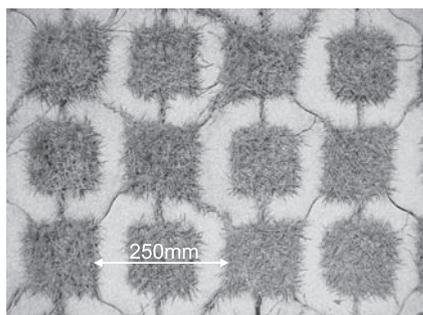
打ち水ガラスパーク表面の様子 (施工約1年後)
